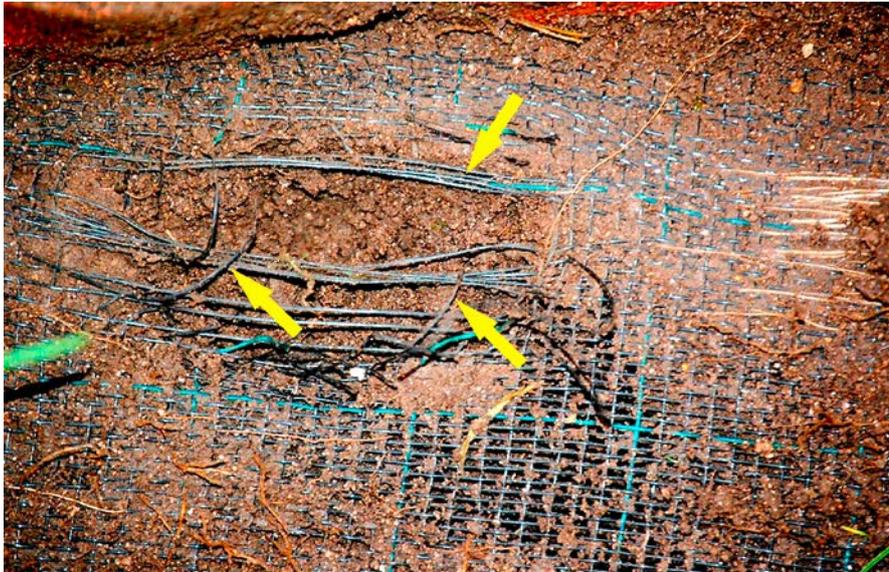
Durch Maulwurf zerrissene Barriere in Folge nicht hinreichender Stabilität der Kreuzungspunkte.
